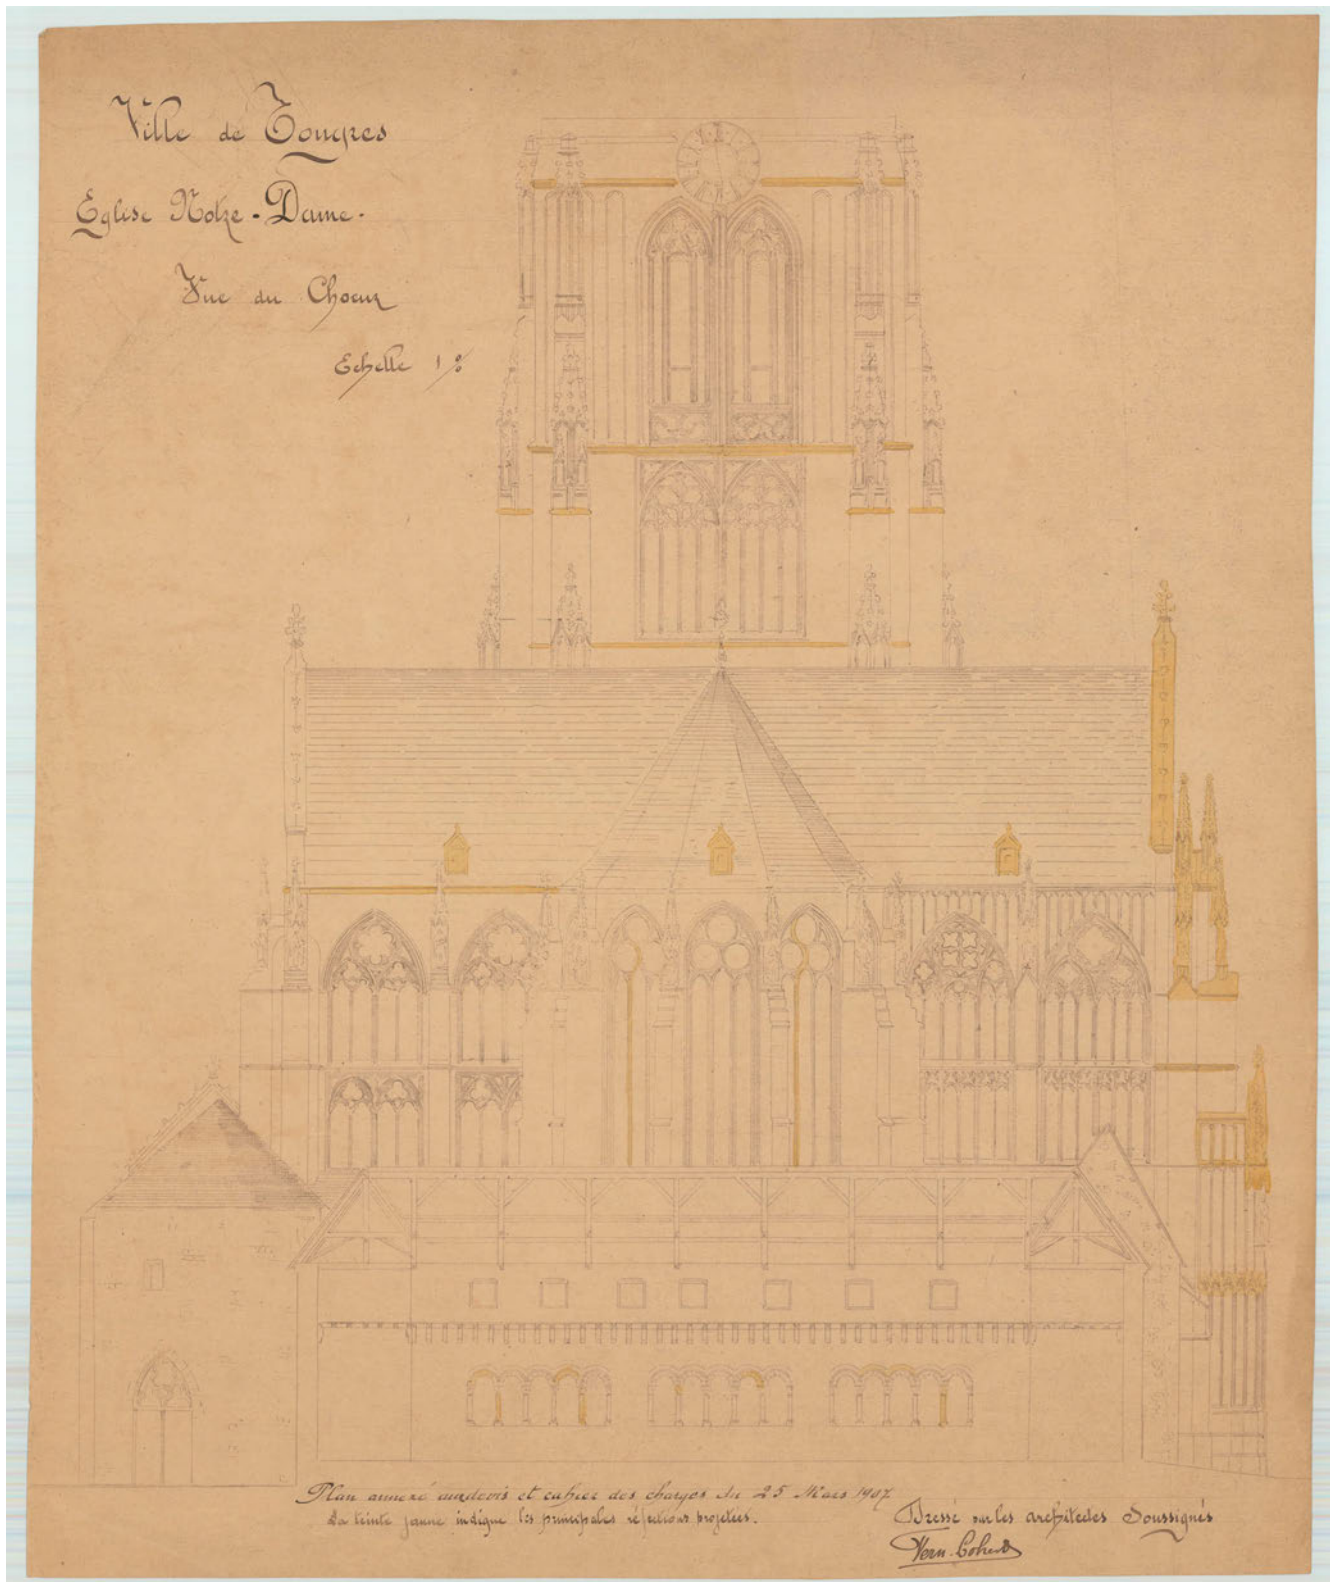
Tongeren: O.L.V.-basiliek: doorsnede van de oostvleugel van het kloosterpand en buitenaanzicht van koor en transept, opgemaakt door architect Fernand Lohest in 1907, wellicht naar een spoorloos origineel van architect Dumont uit 1846 (SAT, Fonds Christiaens).
